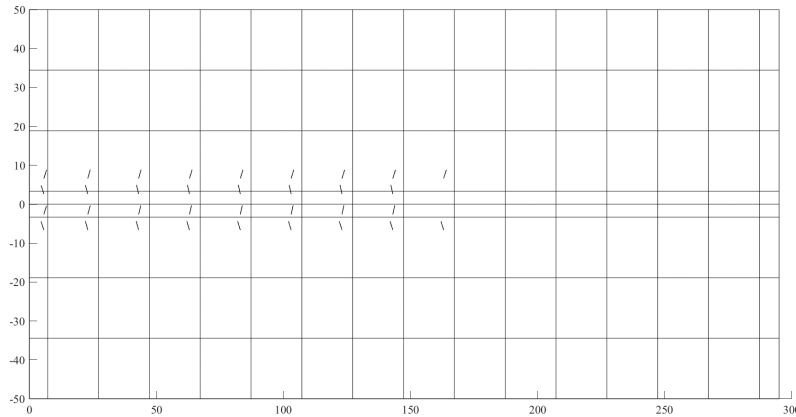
Padrão de fissuração na camada inferior da laje de concreto (viga B1GB60), (passo 18)
